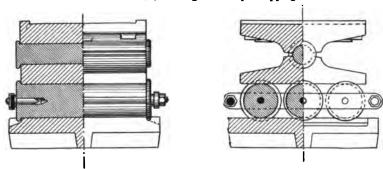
u. 419. Bewegliches Zapfenkipplager.
